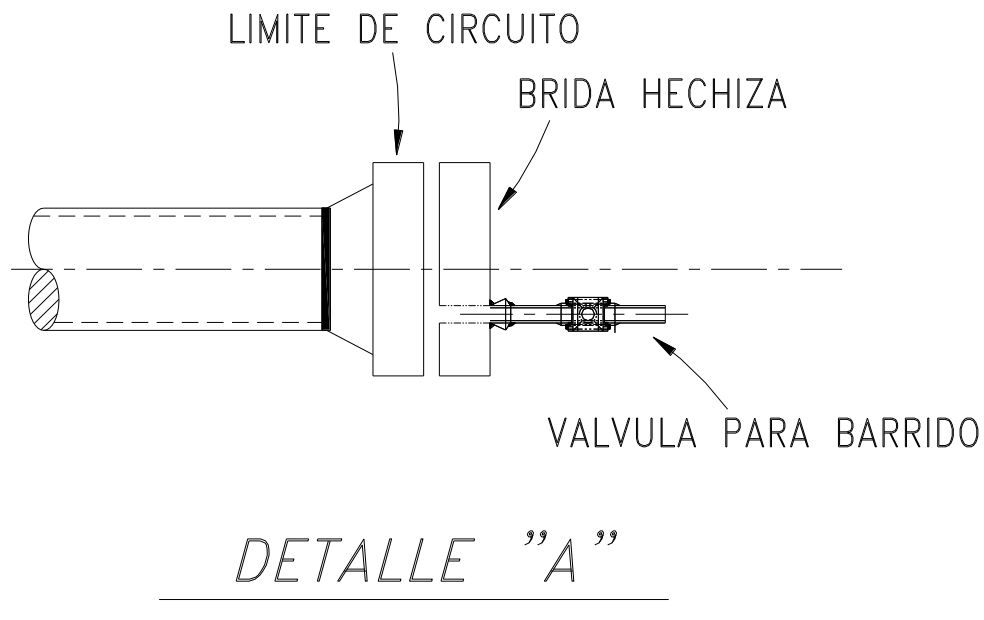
Detalle de instalación arreglo para un barrido de línea.
